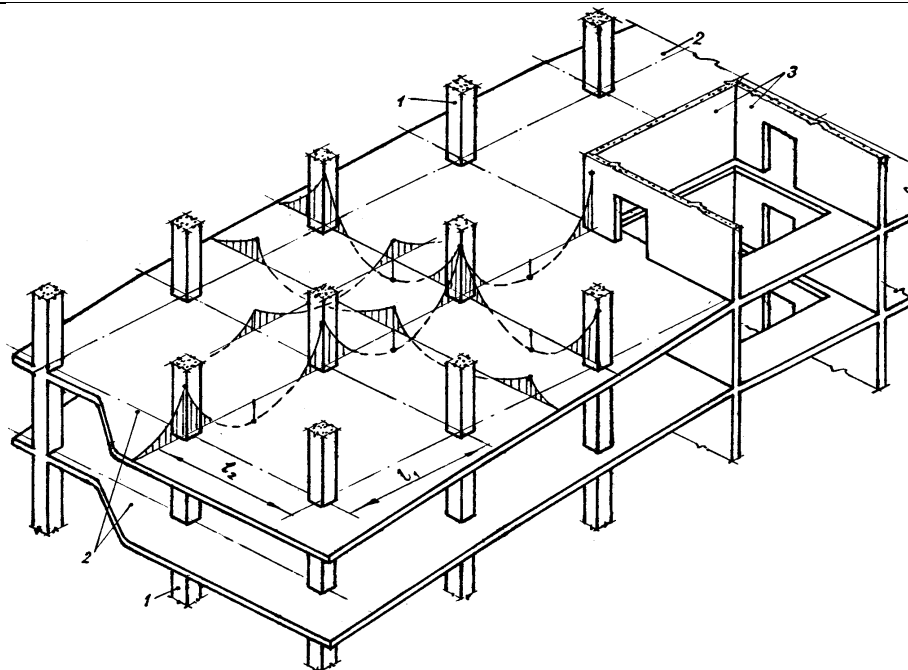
Монолитный железобетонный каркас с безбалочными дисками перекрытий: 1 – колонны; 2 – плоская плита перекрытий; 3 – ограждение лестничной клетки (вертикальные диафрагмы жесткости)
